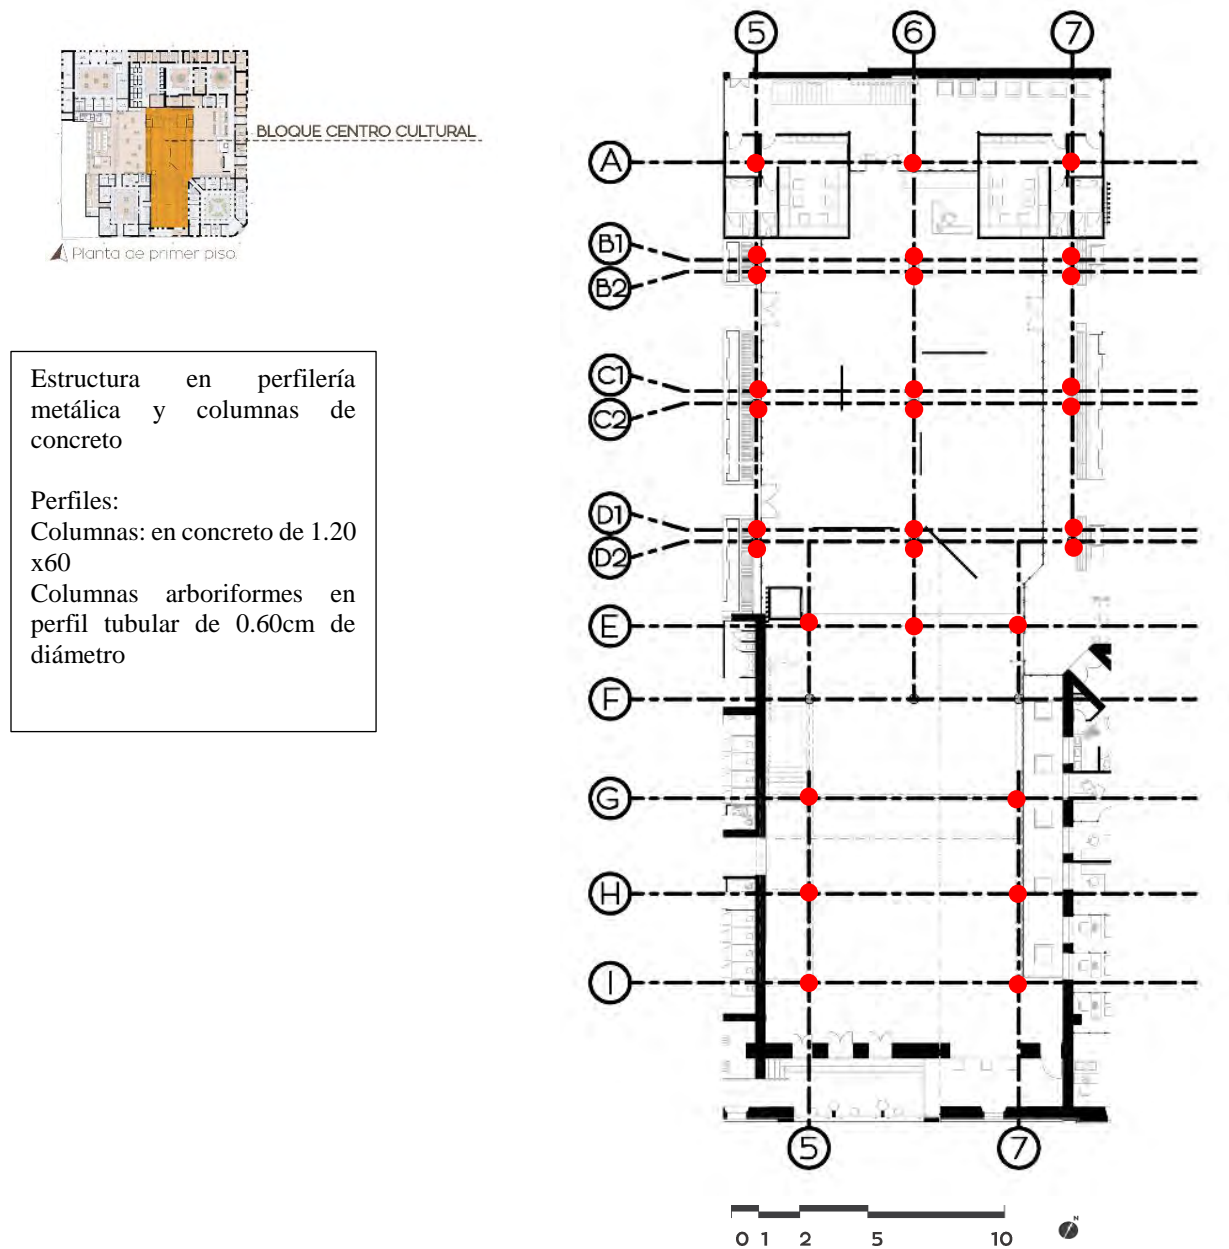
Propuesta estructural bloque B. Fuente: Elaboración Propia.
